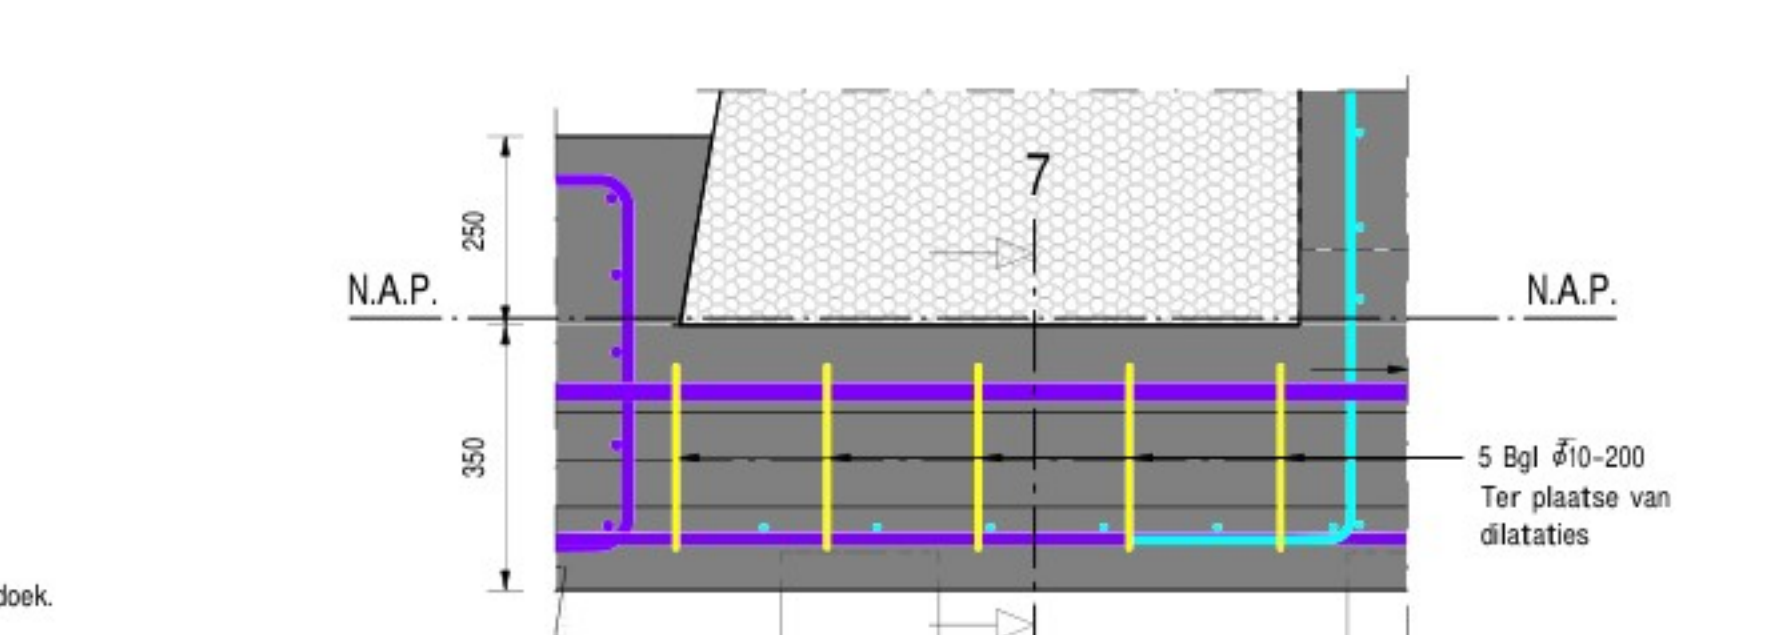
TUSSEN BESTAANDE BALKEN
